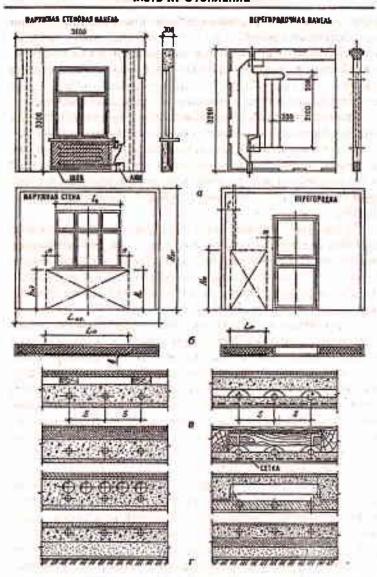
Отолительные бетонные панели: а — стеновые и перегородочные; б — размеры панелей; в — потолочные; г — напольные
